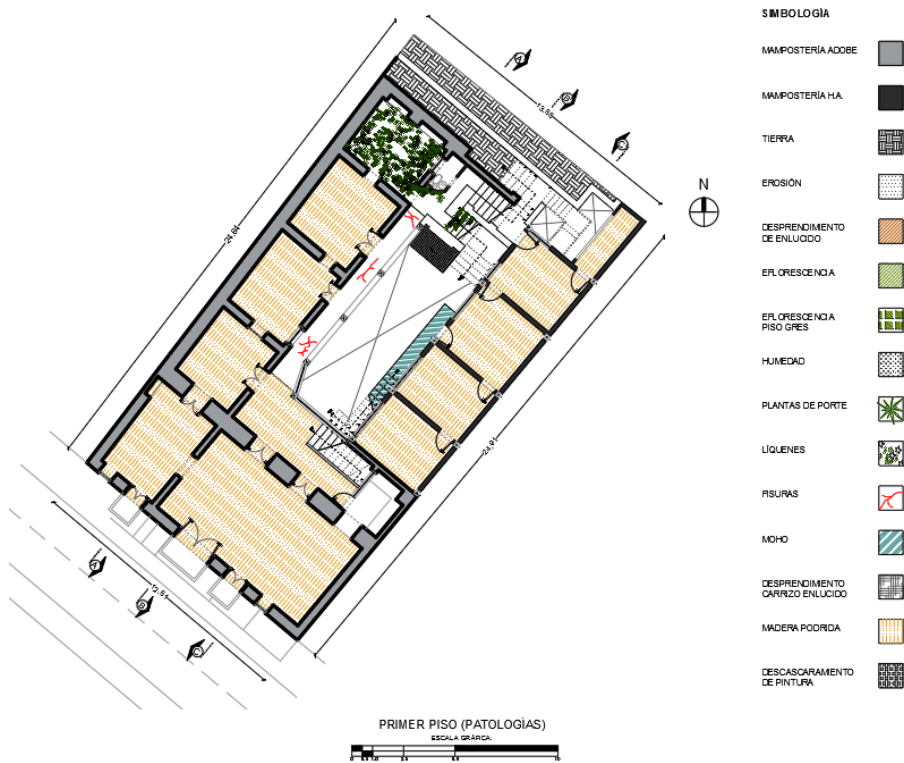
Patologías primer piso • Fuente: Ilustración Propia
